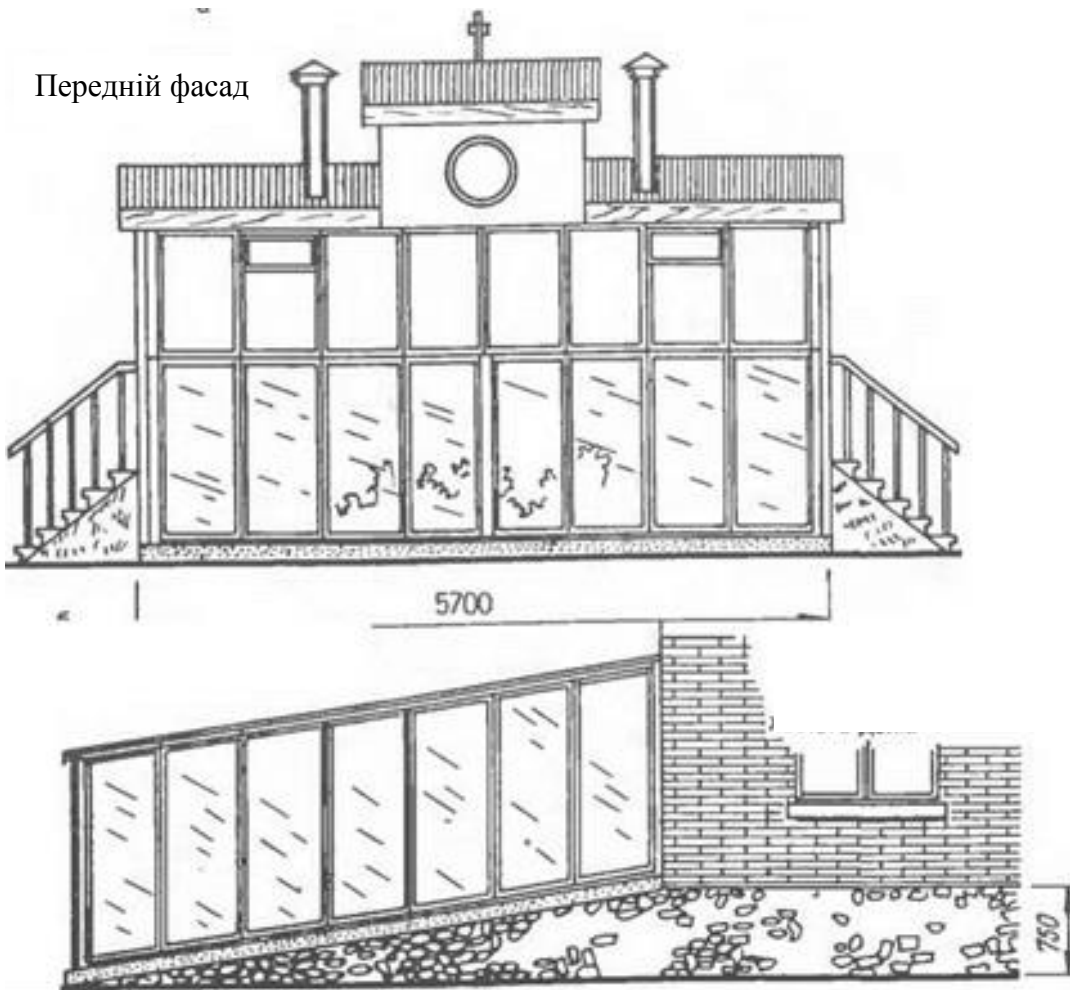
Сонячний вегетарій на рівній ділянці з насипним ухилом (15°) та з заглиблення його передньої частини: а - бічний (східний) фасад; б – передній фасад; в - варіант примикання вегетарію до південної стіни житлового будинку
